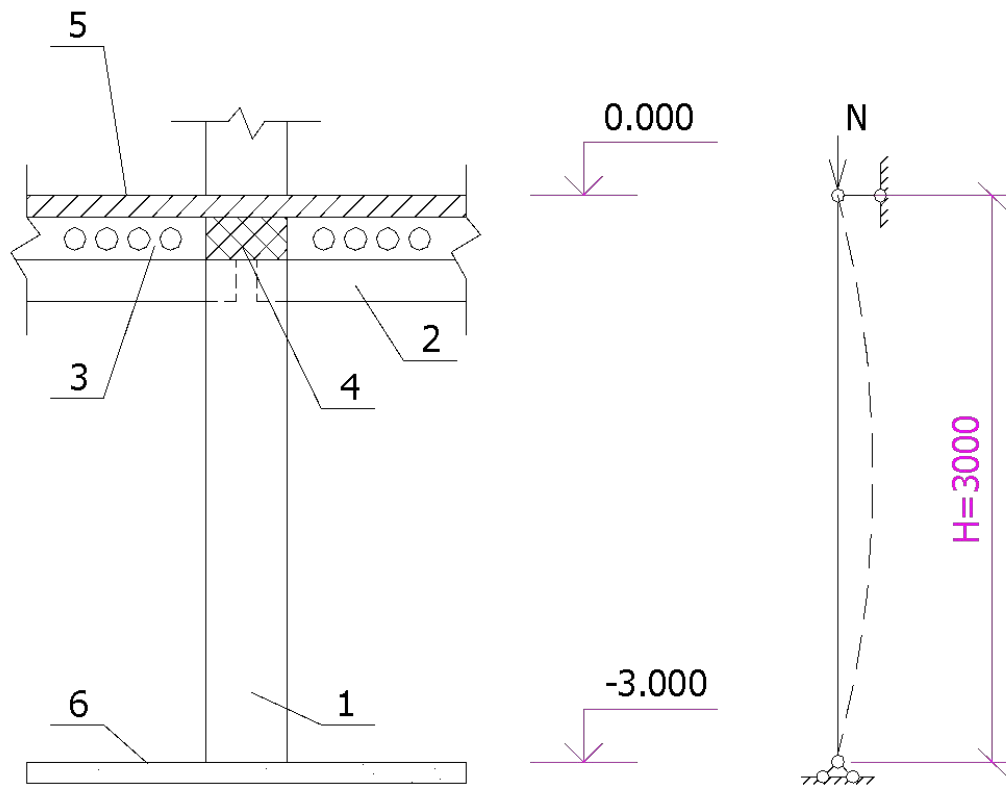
Расчетная схема центрально нагруженного каменного столба подвала: 1 – каменный столб; 2 – железобетонный ригель; 3 – плиты перекрытия; 4 – монолитные участки перекрытия; 5 – конструкция пола; 6 – бетонный пол
